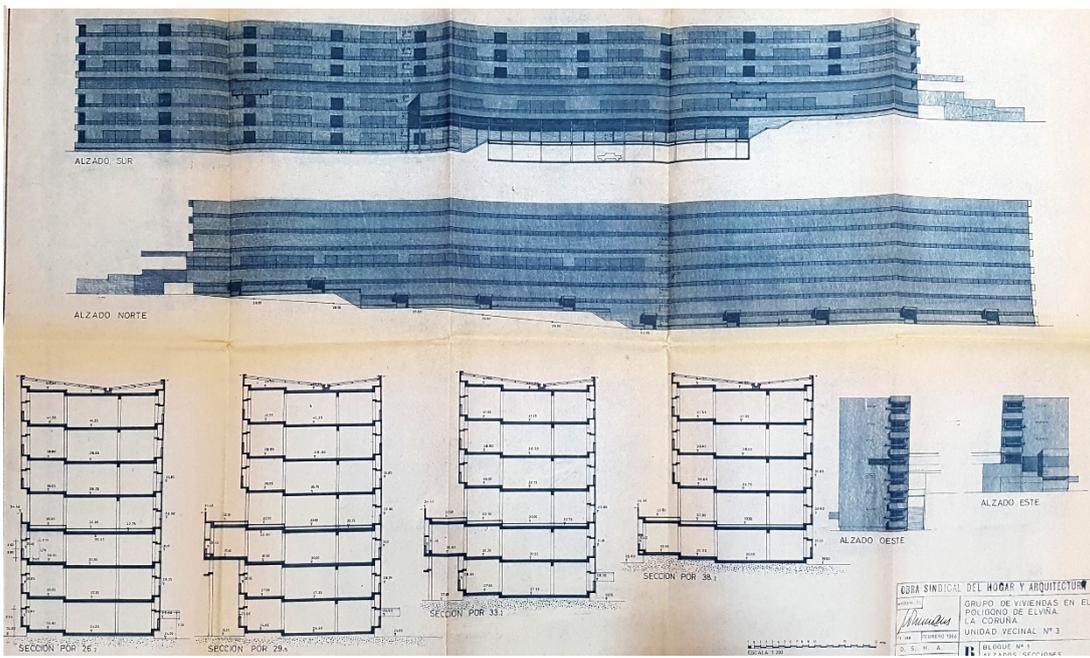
Alzados y secciones Bloque N°1. 1964. Fuente: Archivo Municipal da Coruña
